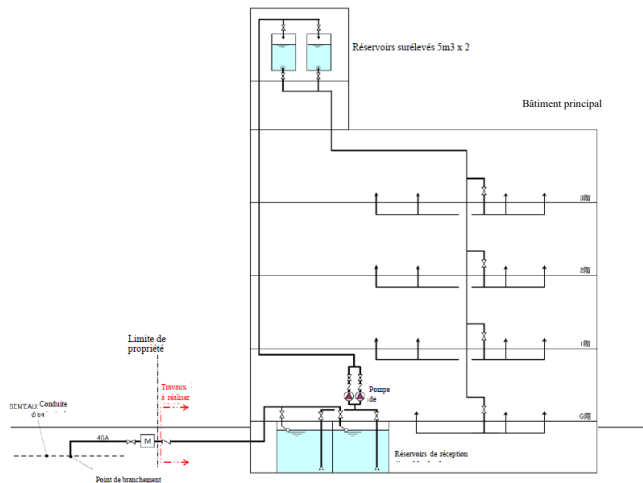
Schéma du système d'approvisionnement en eau
